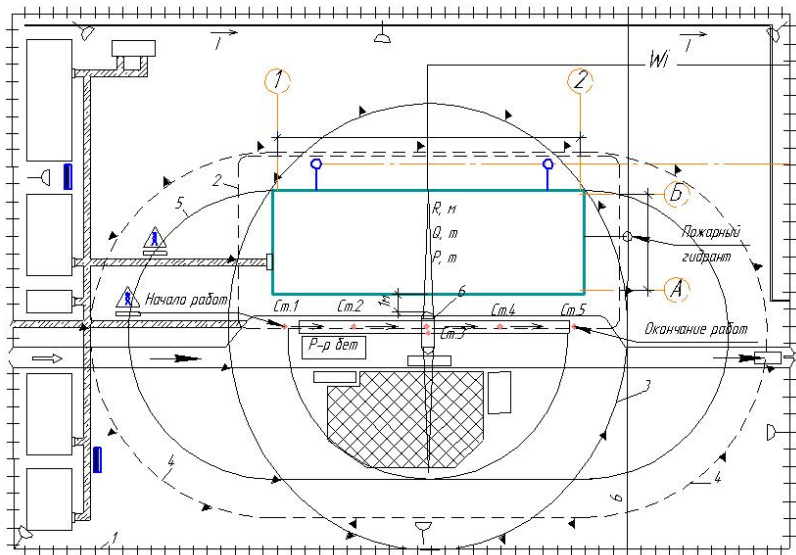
Границы зон при работе стрелового крана (крана-манипулятора): 1 – ограждение строительной площадки; 2 – граница опасной зоны вблизи строящегося здания; 3 – граница зоны, опасной для нахождения людей во время перемещения, установки и закрепления элементов и конструкций на одной стоянке; 4 – то же, с учетом всех стоянок; 5 – граница зоны обслуживания краном; 6 – стреловой кран
